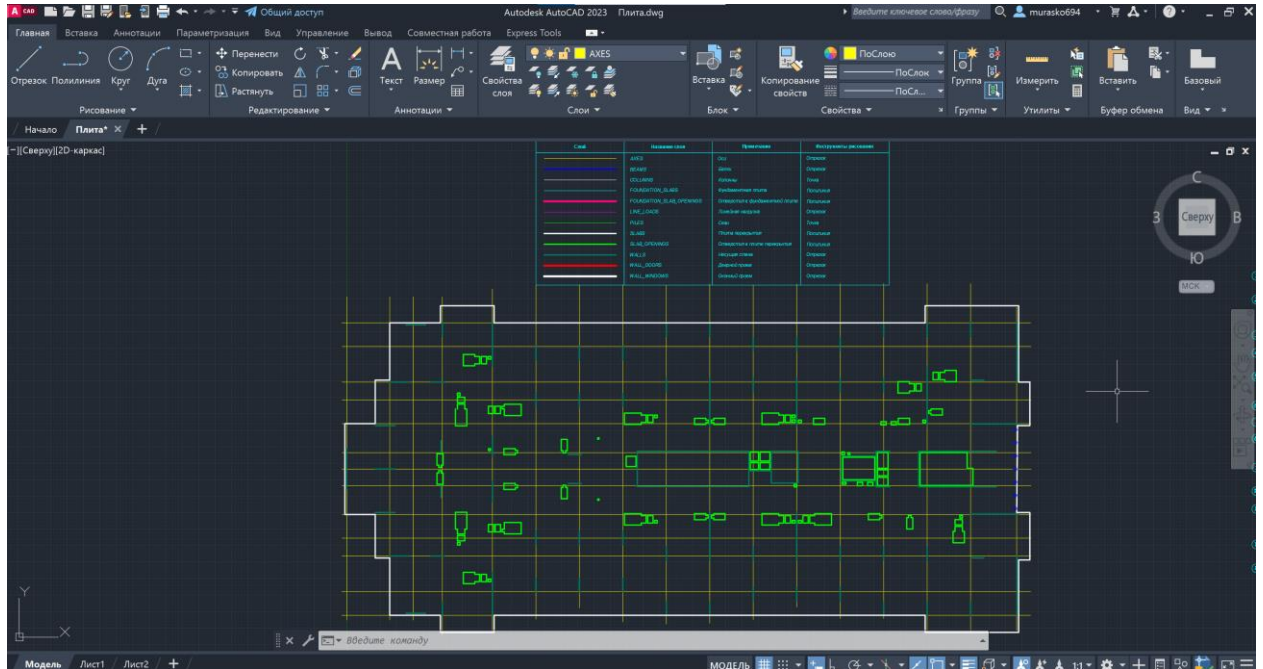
Схема-модель типової плити перекриття в AutoCAD
